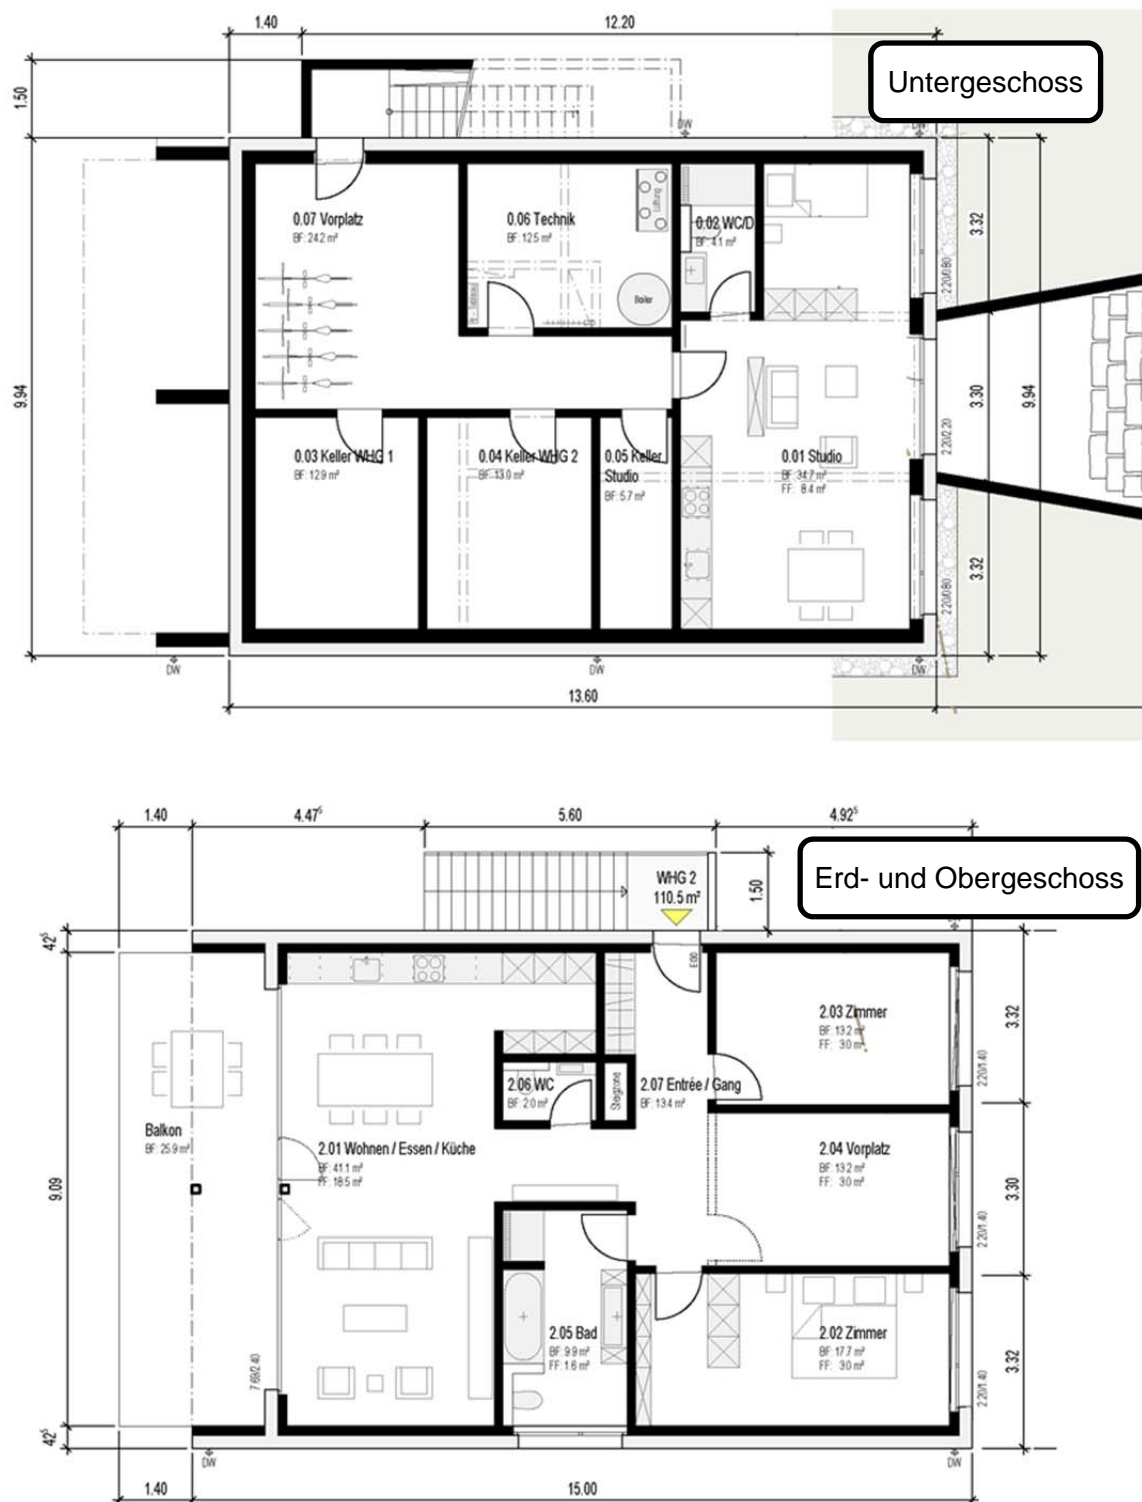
Grundrisse Unter-, Erd- und Obergeschoss (Quelle: Setz Architektur).
